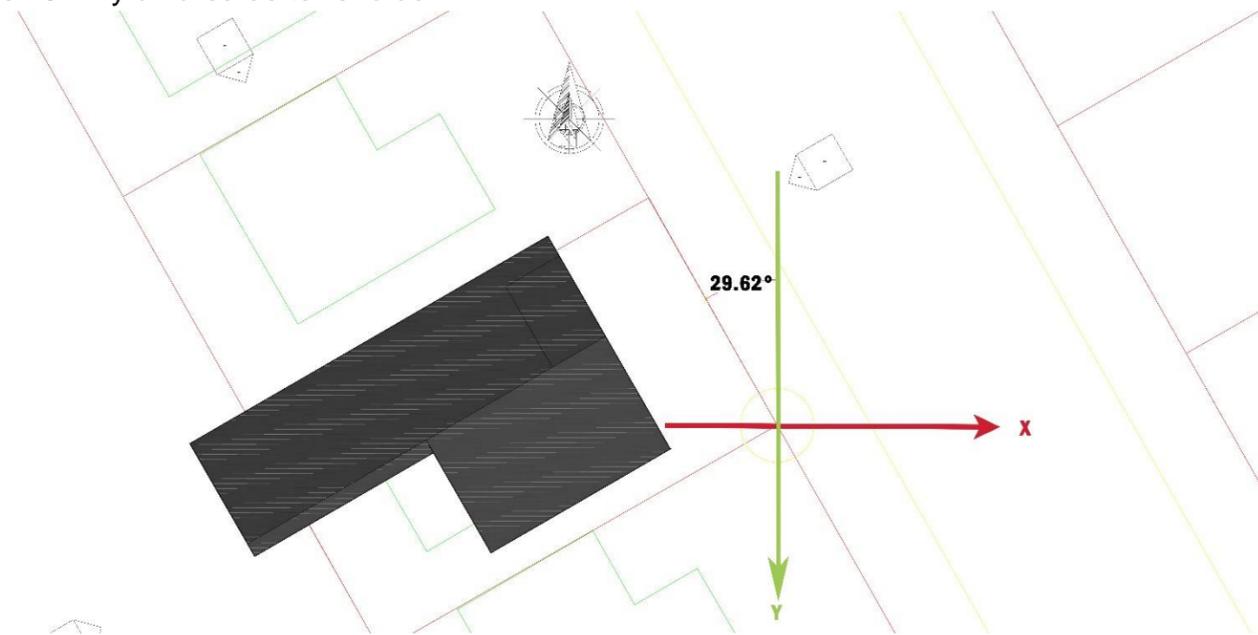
Plano de distribución de techos de vivienda H-4 ubicado en el conjunto con plano cartesiano. Elaborado por las autoras.
